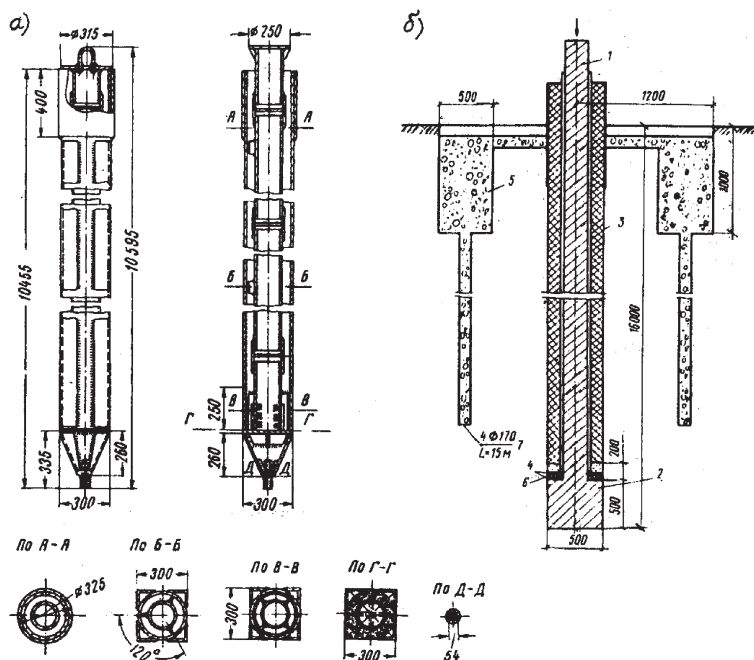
а*) Конструкция инвентарной сваи-штампа. *б*) Схема испытаний набивной сваи-штампа с локальным замачиванием основания: 1 – бетонный стержень; 2 – уширение; 3 – полый бетонный цилиндр; 4 – фланцы; 5 – кольцевая траншея; 6 – пакля; 7 – скважина
